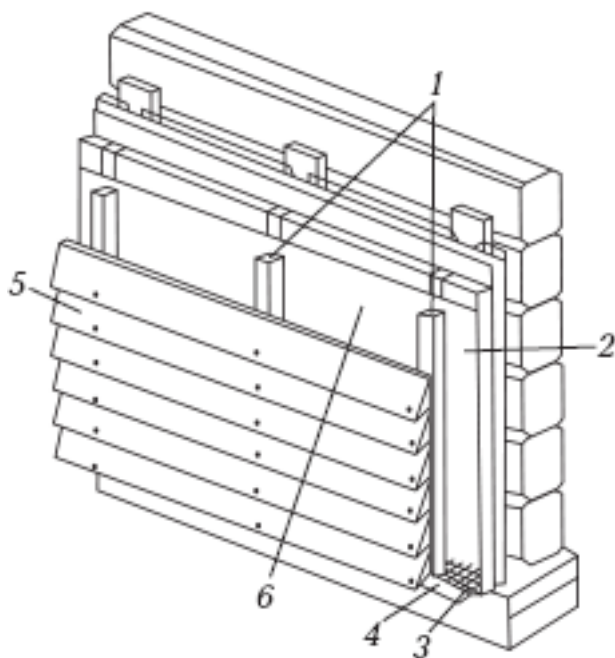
Укладка ветроизоляции и финишной обшивки: 1 – каркас для обшивки; 2 – ветроизоляционный слой; 3 – металлическая защитная сетка; 4 – дополнительная планка, применяемая при обшивке досками внахлест; 5 – обшивка; 6 – самоклеящаяся лента, герметизирующая место стыка полос ветроизоляции
